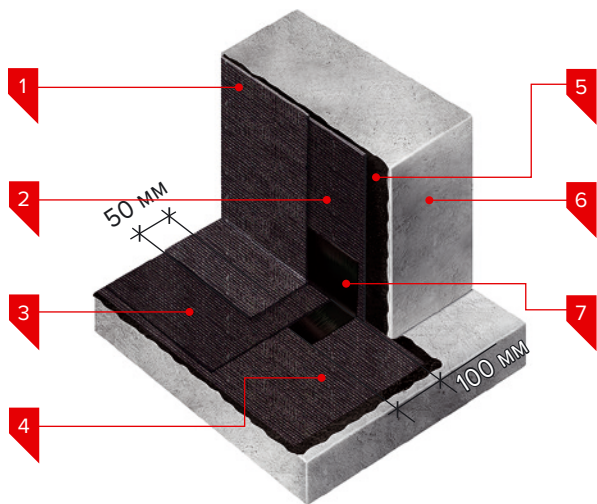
Техноэласт Фундамент. Обустройство внутреннего угла без применения галтели при смене направления укладки гидроизоляционной мембраны:
